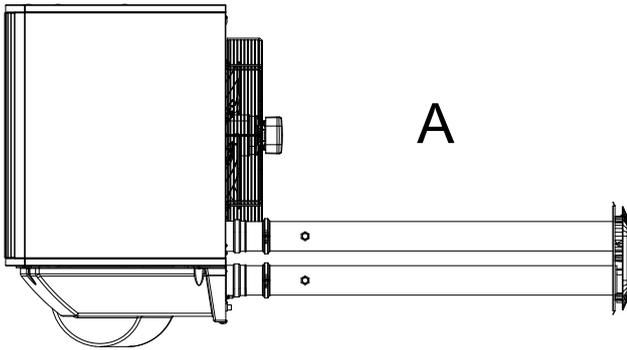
Installazione tipo B23 con tubo fumi a tetto Ø 80
